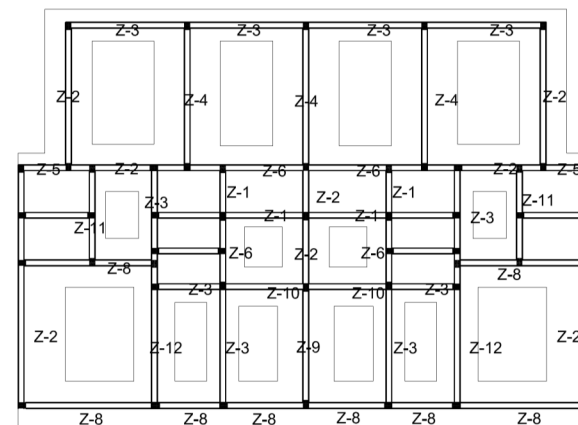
Planta de cimentación tipo con zapatas corridas del área de vivienda.
